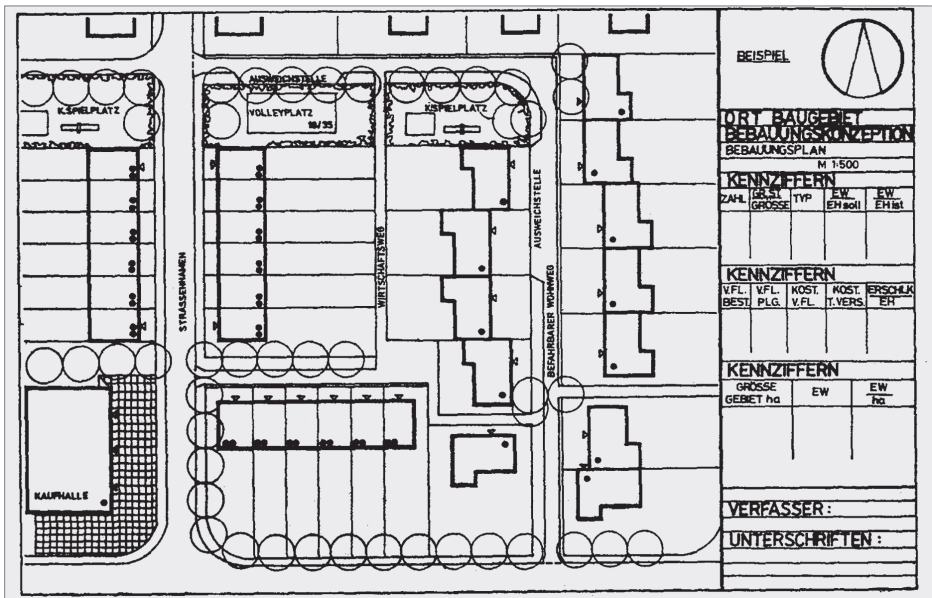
Bebauungskonzeption, Bebauungsplan – Beispiel.
